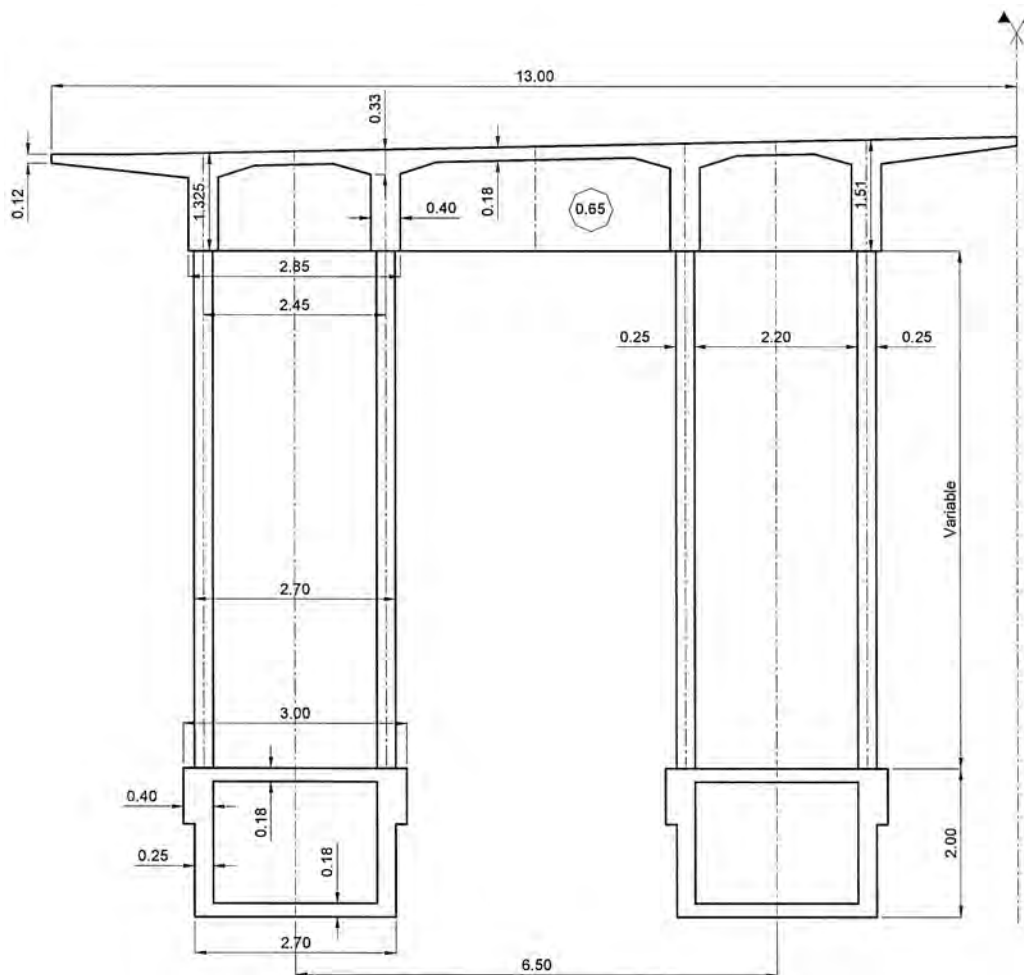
coupe transversale d'un ouvrage au droit d'une pilette
